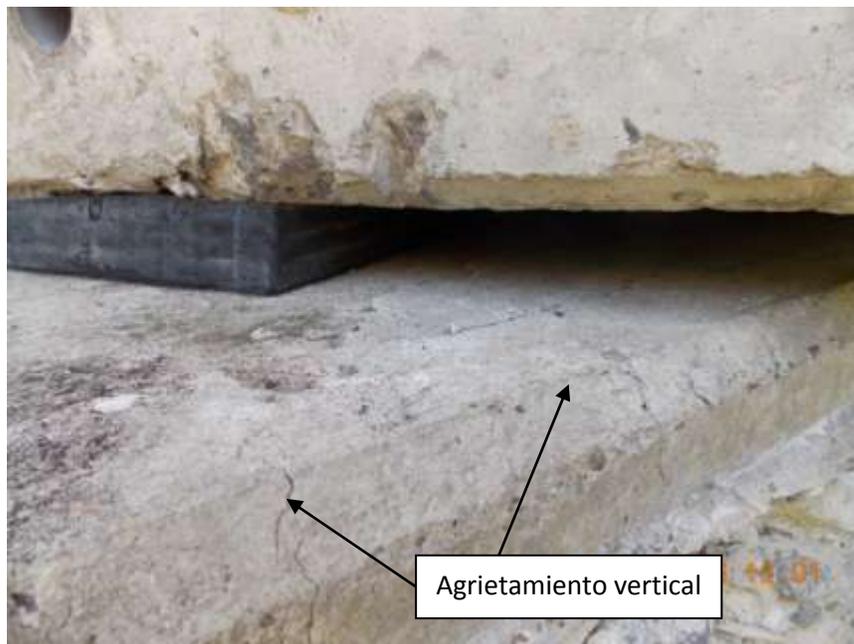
Puente sobre río Estero Negro. Agrietamiento en la zona de los apoyos de la pila del lado de Limón.
